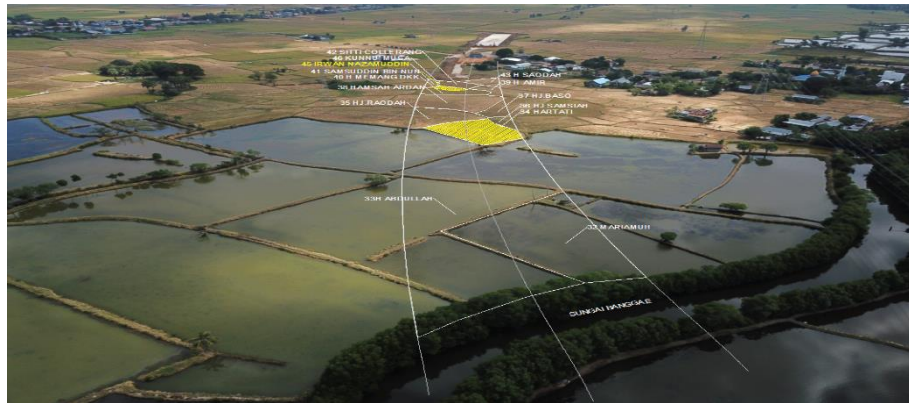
Layout Proyek Area Km 32+600 s/d 36+600
